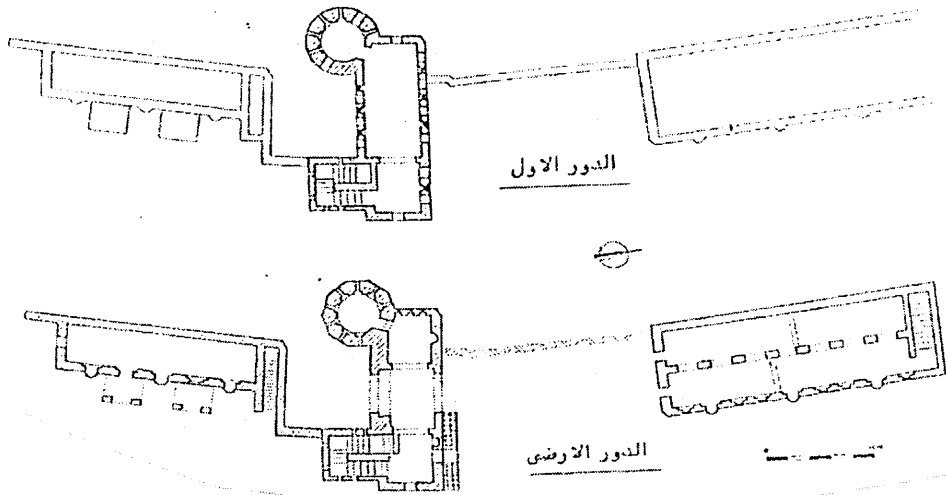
زبيد، المسقط الأفقي لباب سهام
